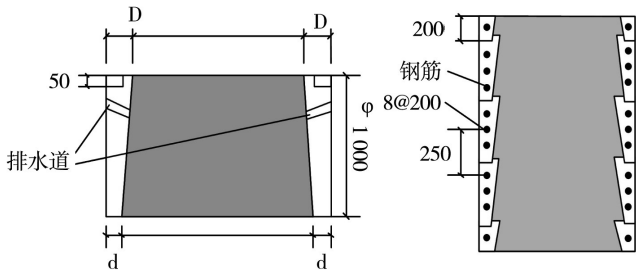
人工挖孔桩护壁施工以及护壁加筋施工工艺示意图
